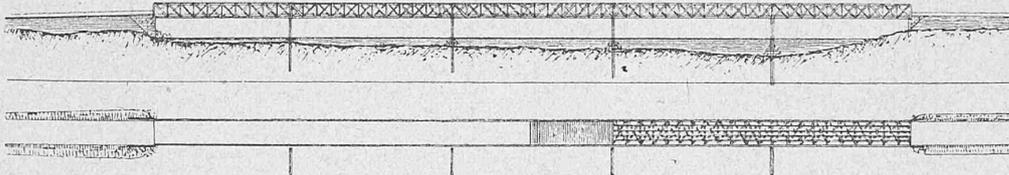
und 3. Gesamt-Ansicht und Grundriss.
